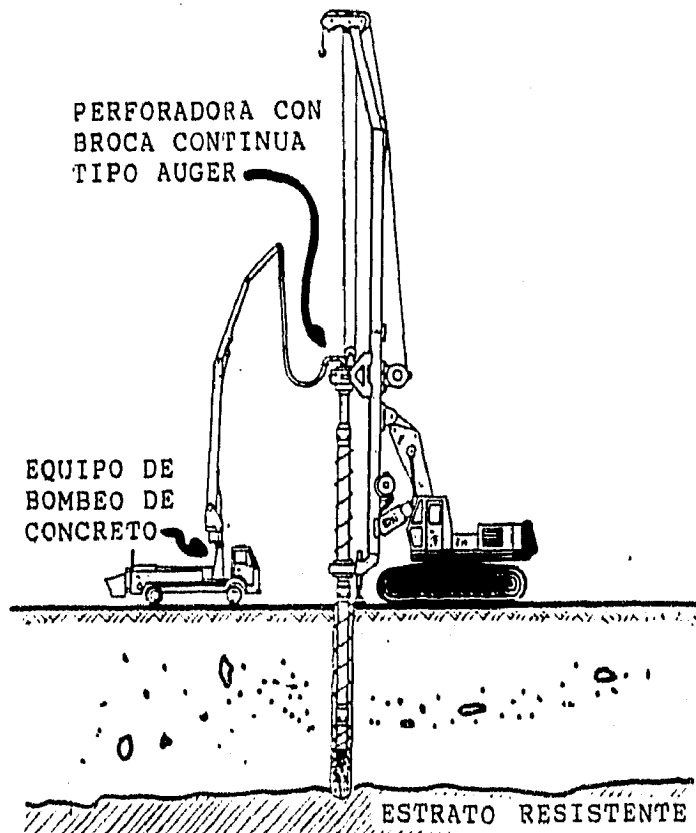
PILOTE FABRICADO POR INYECCIÓN.
